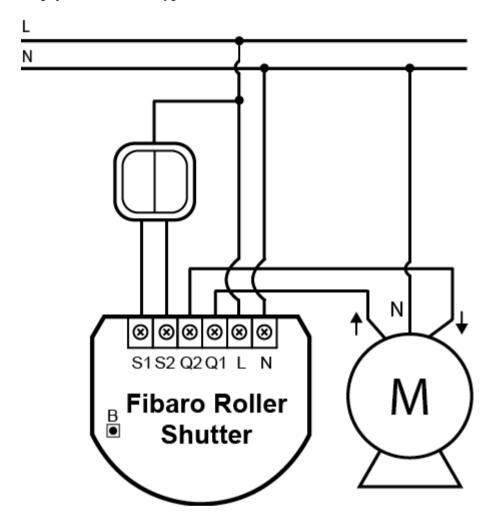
Fibaro Roller Shutter 2 (29)
